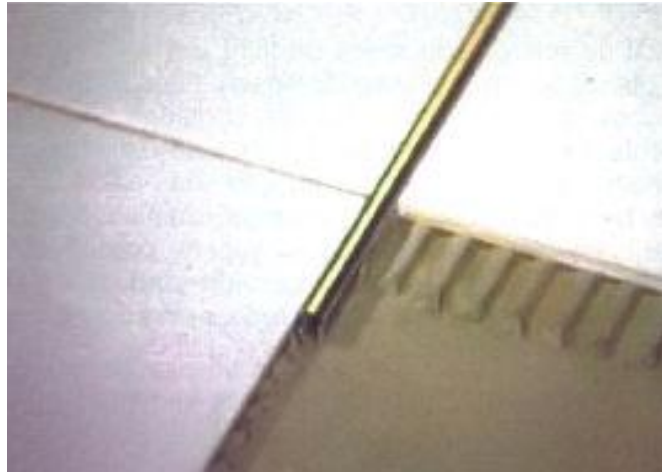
Junta de esquadramento executada com perfil prefabricado [30]
